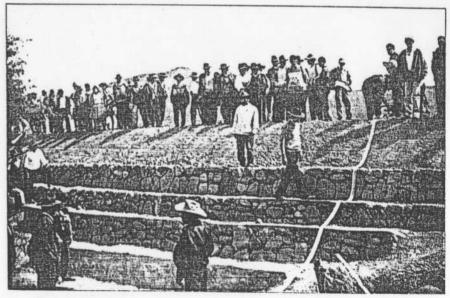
Talud exterior protegido a deslizamientos mediante terrazas de banco
